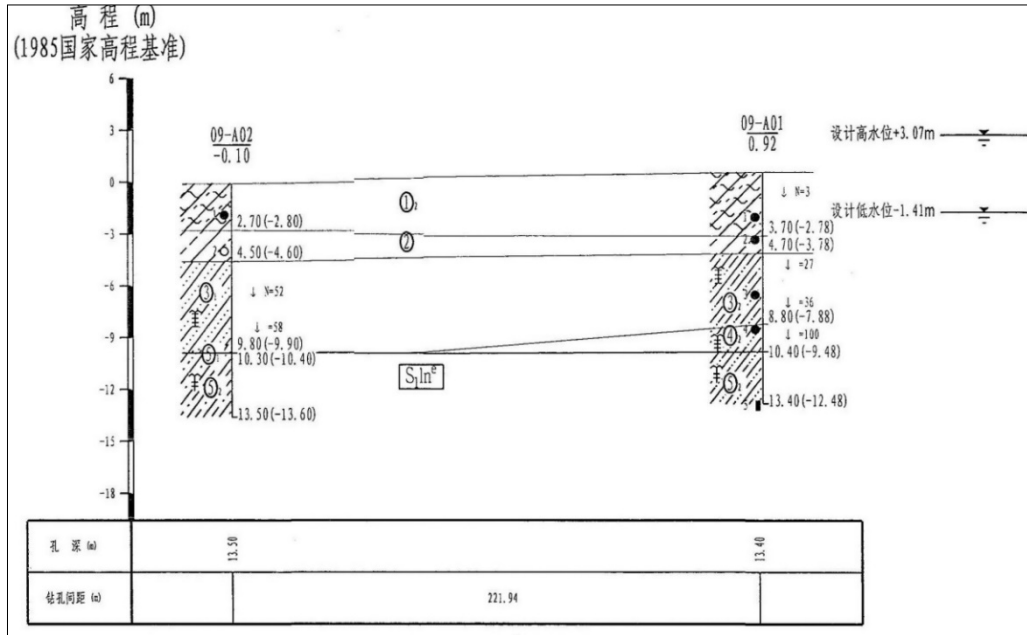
地质剖面图 (A6-A6' 剖面)
